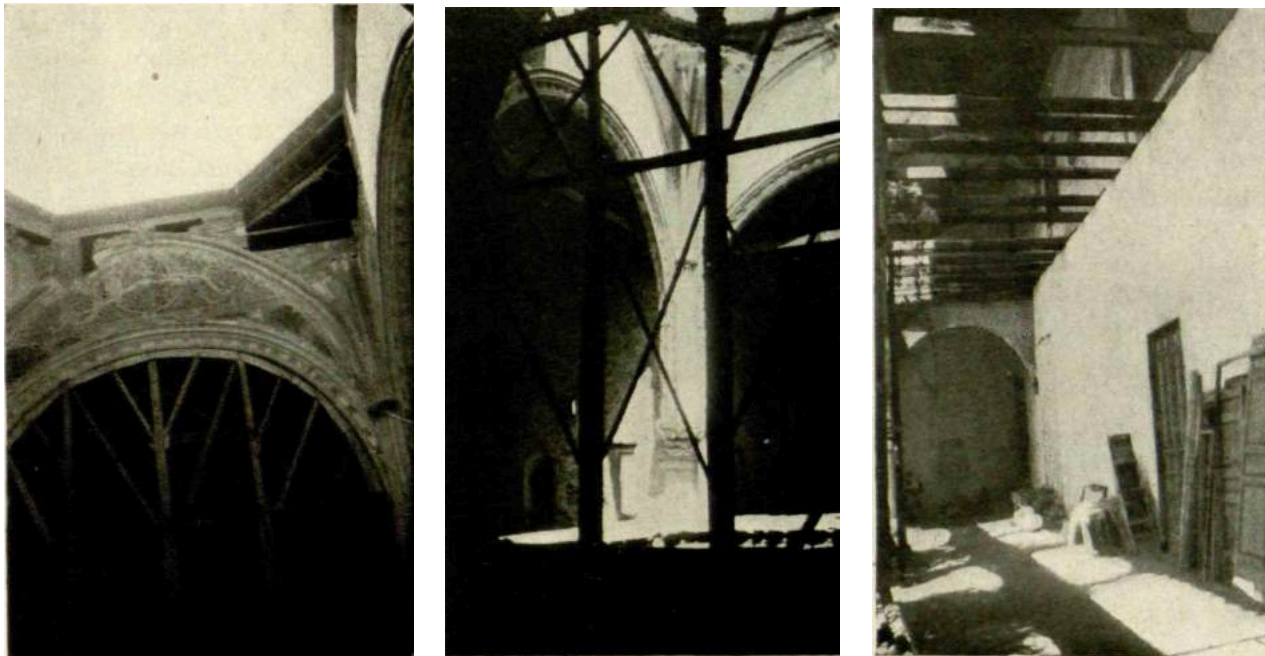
Vistas del crucero con sus arcos apuntalados y destruida la balaustrada y segundo patio
